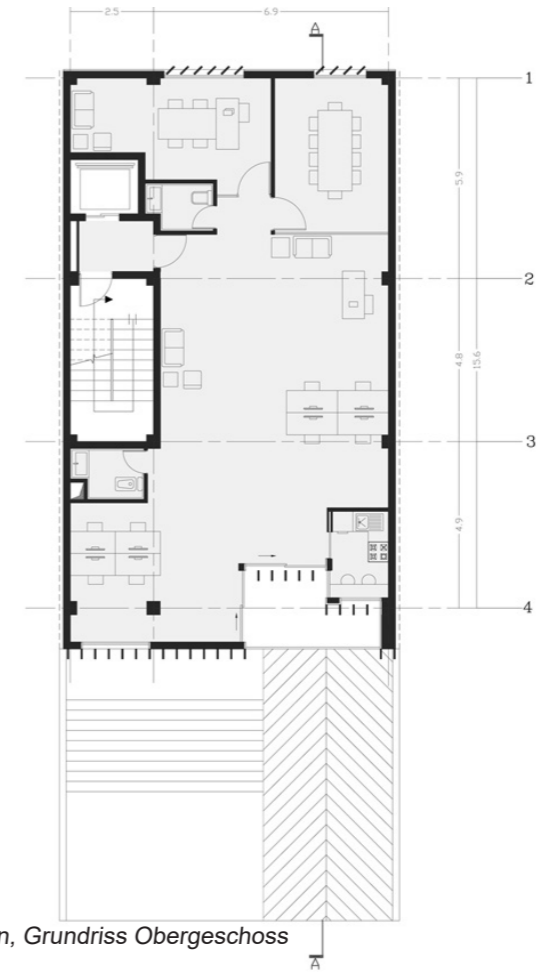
Office block, Teheran, Grundriss Obergeschoss
